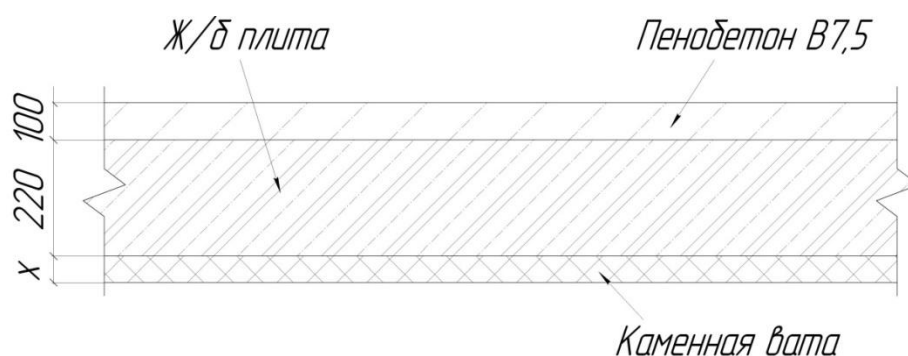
Послойный состав конструкции перекрытия, находящегося над подвалом
